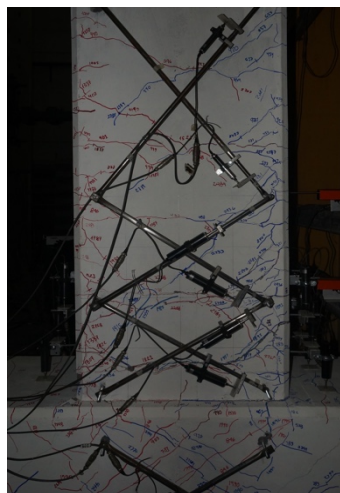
Grietas, la prueba ya está avanzada
